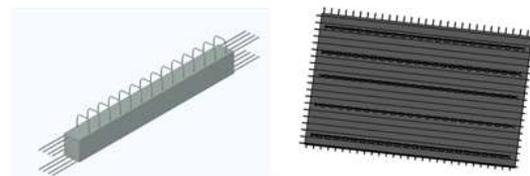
预制混凝土叠合梁 图 2.4-2 非预应力钢筋混凝土叠合板
